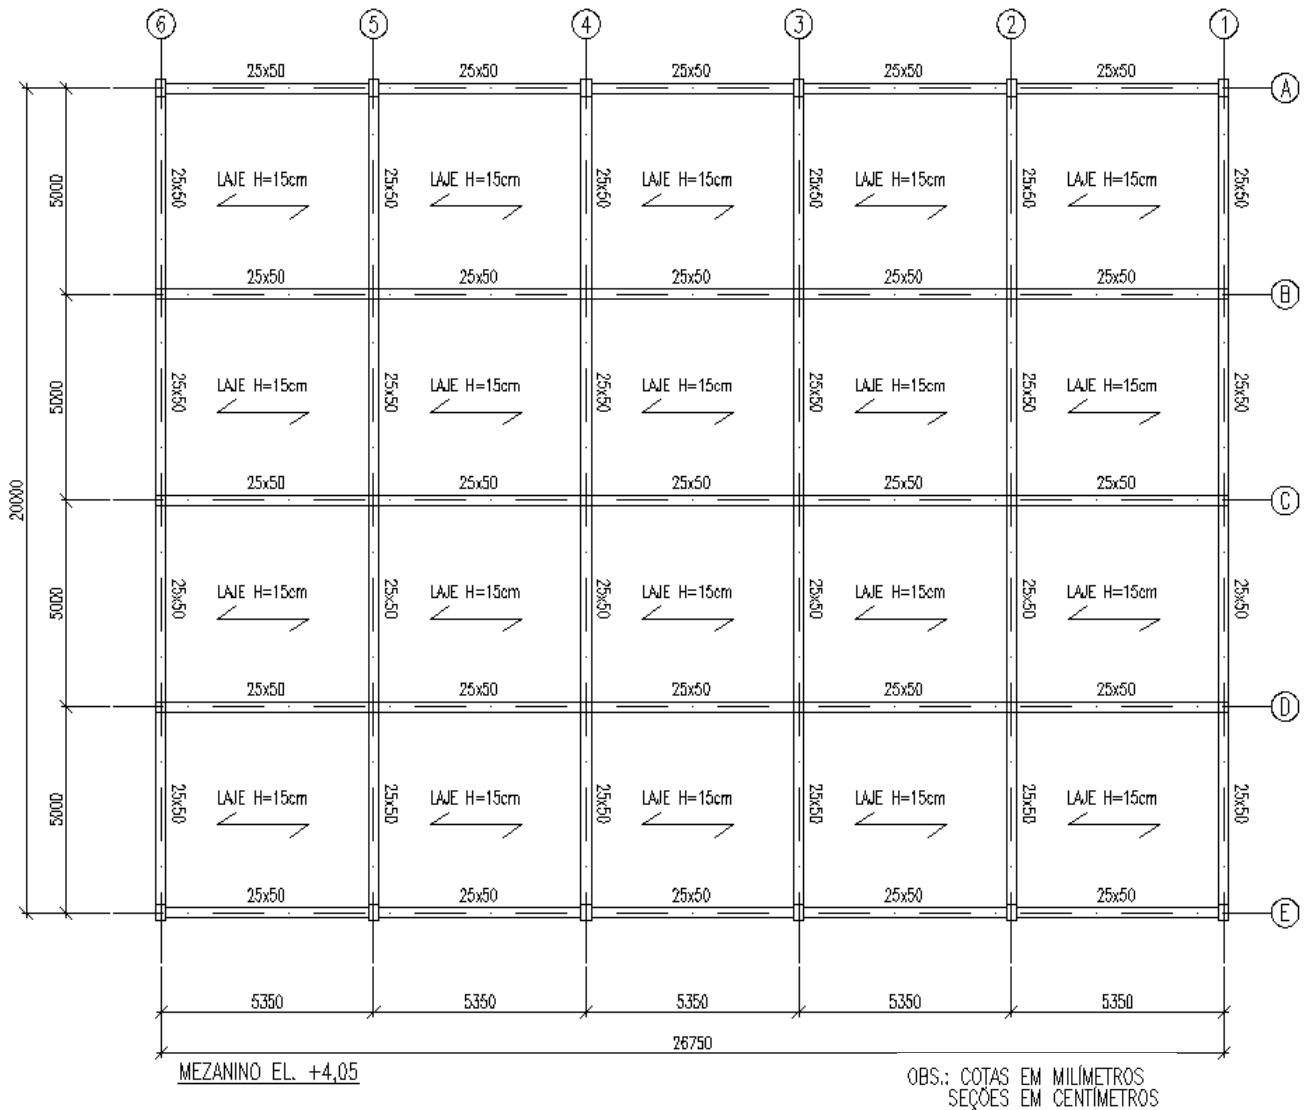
Planta baixa de locação das vigas do mezanino em concreto pré-moldado.
